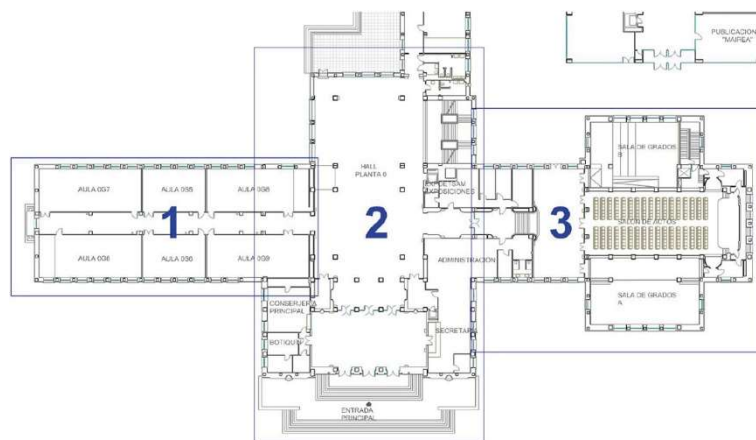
Planta ETSAM: ámbito de actuación. Fuente: ETSAM-UPM (2020)
